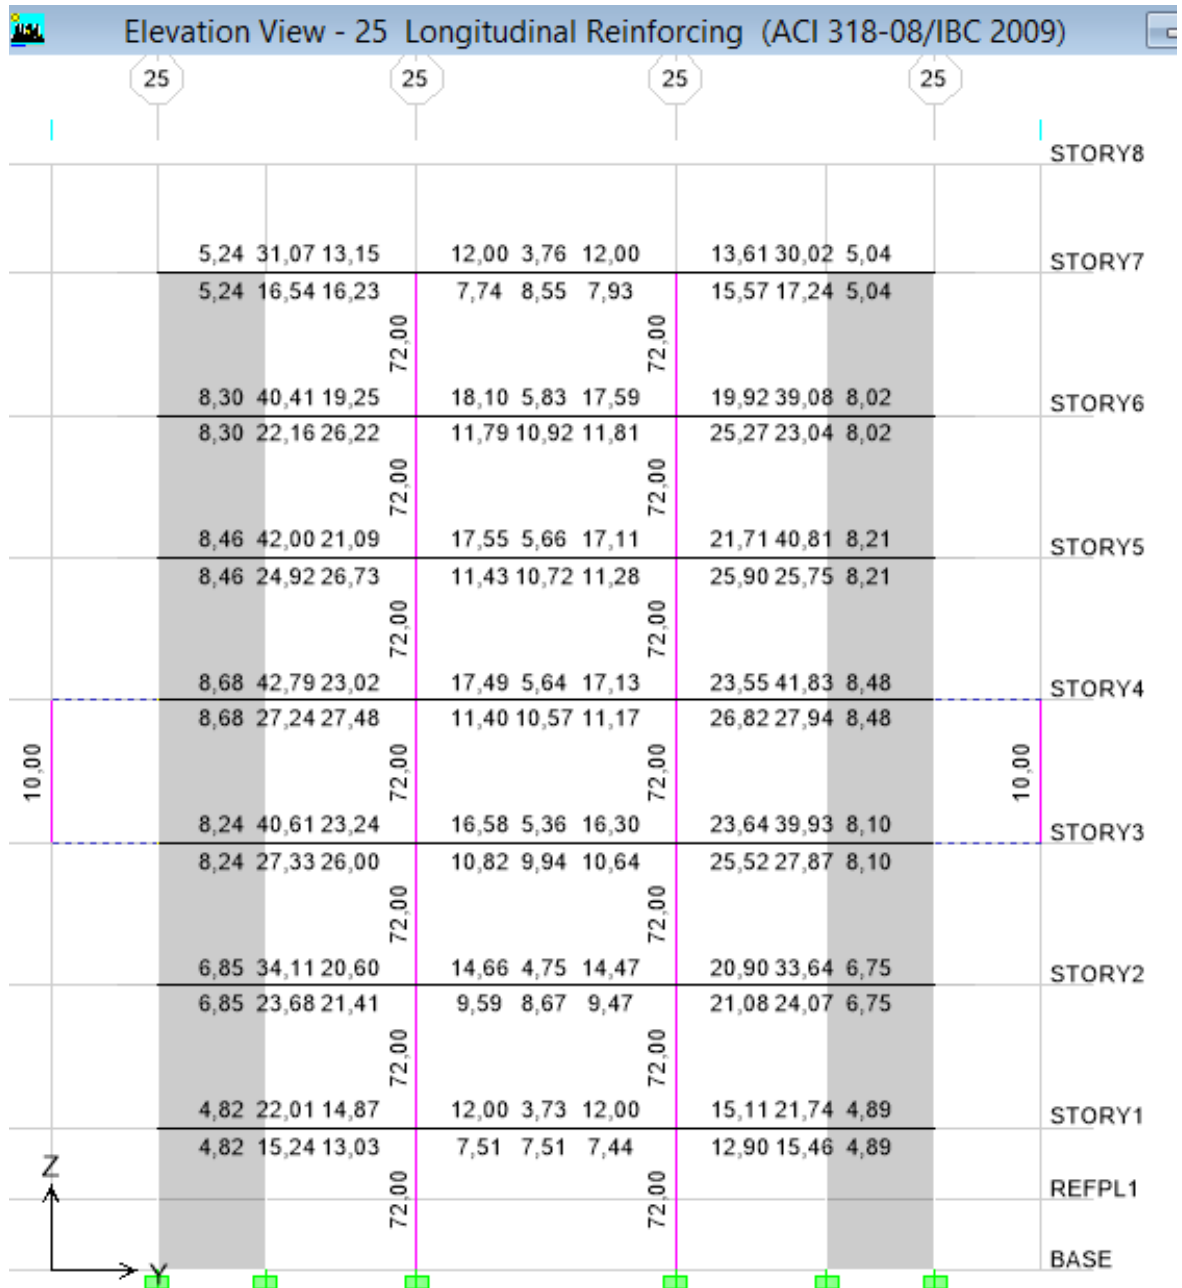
Acero en Vigas y Columnas en el Pórtico 25 – Hospitalización 2- (CEC-2002)
